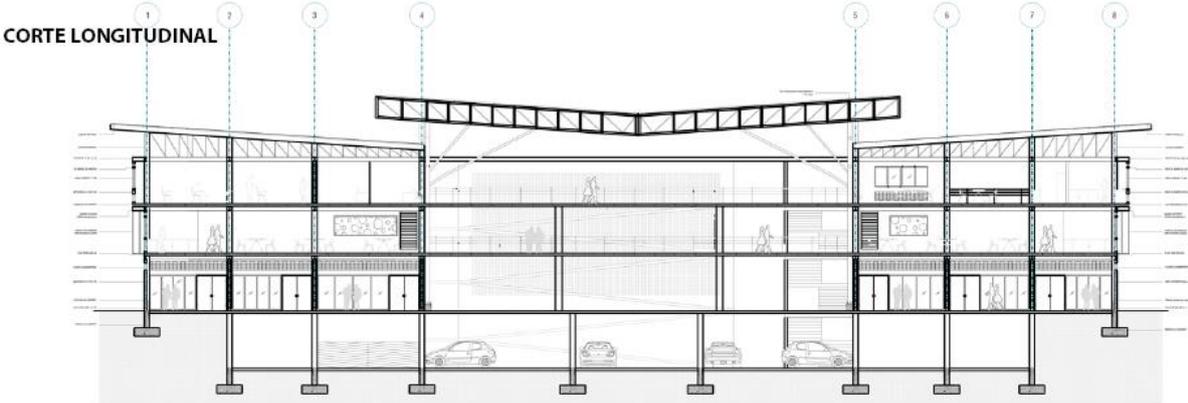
Corte longitudinal. Fuente: Elaboración propia
